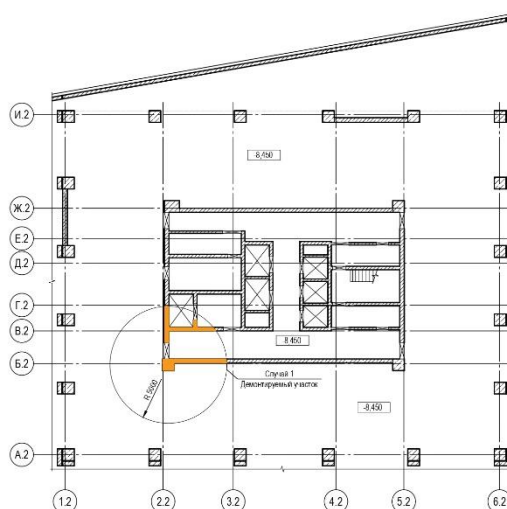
Корпус К-2. Схема аварийного случая 1
